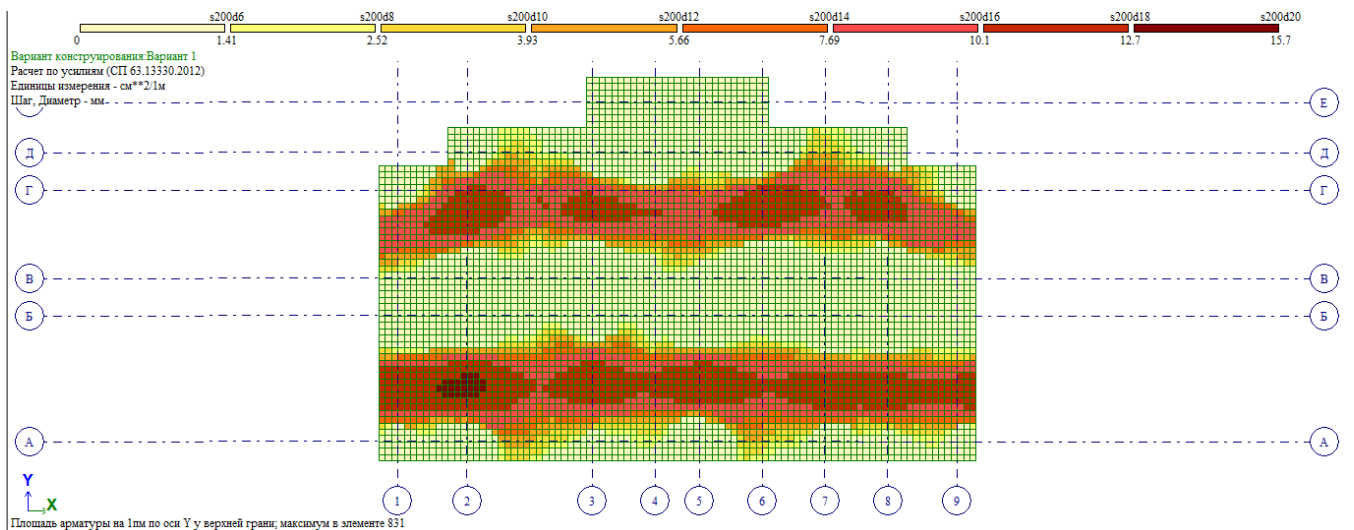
Схема верхнего армирования фундаментной плиты по оси Y
